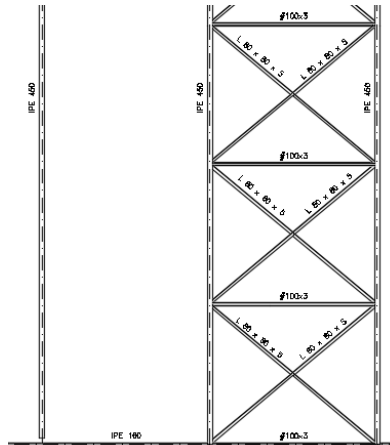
Viga Pratt faldón A. (Fuente: Cype 3D)
